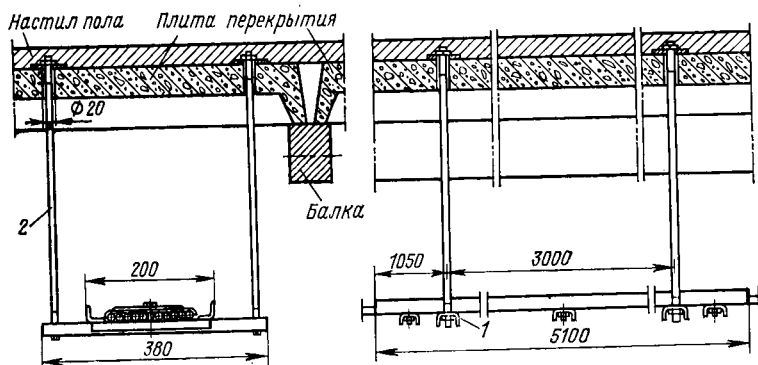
Крепление к потолочному перекрытию блока труб на несущем каркасе.
